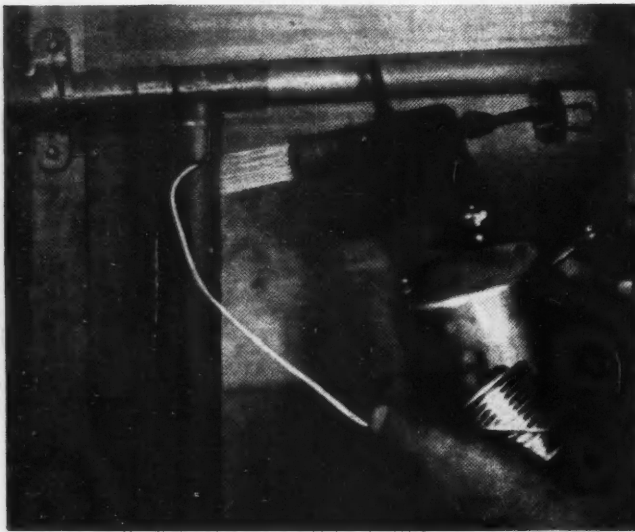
LA SOUDURE PAR CAPILLARITE DU TUBE EN CUIVRE.
